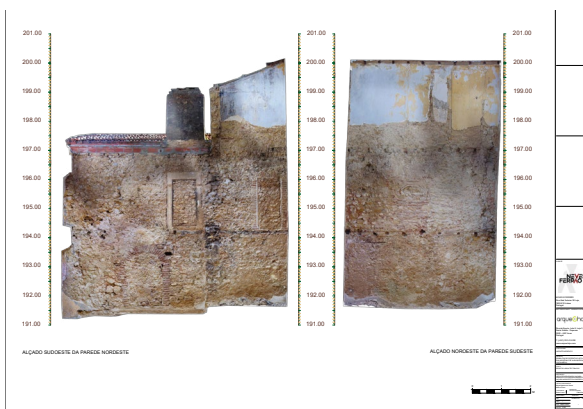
Ortofotografia do alçado sudoeste da parede nordeste e do alçado noroeste da parede sudeste (autores: Fábio Rocha e Sónia Cravo).
